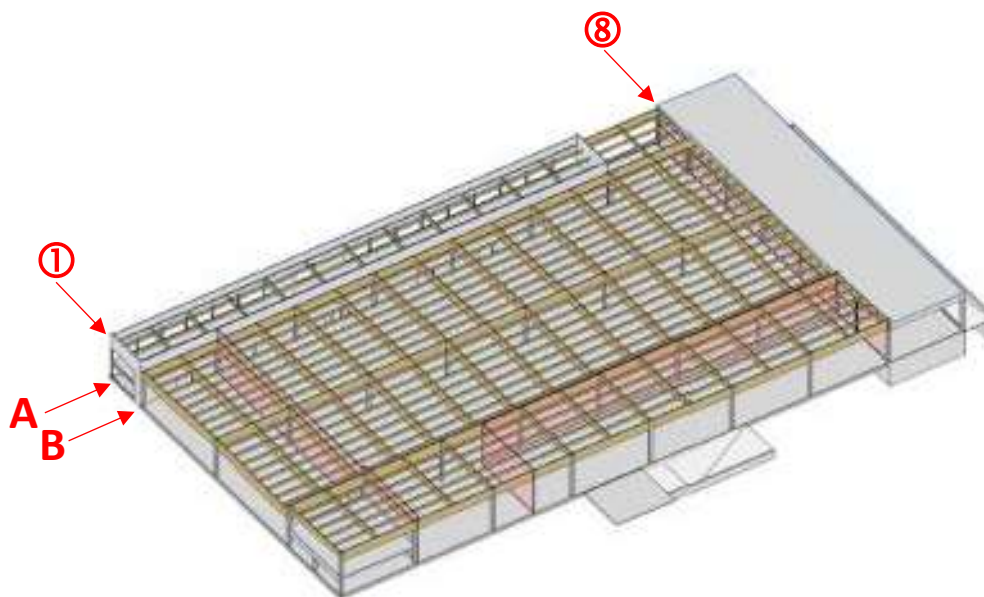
PLAN DE LA CHARPENTE (FILES 1 A 8)
